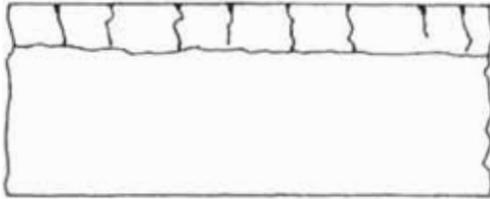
Fisura por contracción en concreto fresco sobre concreto colocado con anterioridad.
